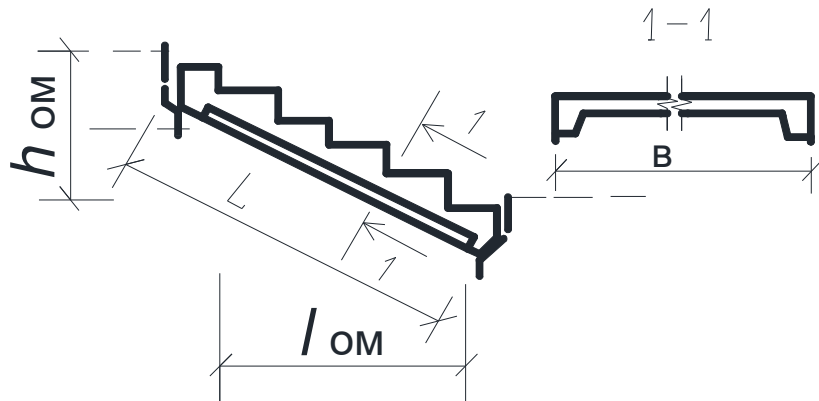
Марши ребристой конструкции (с фризowymi ступенями)
